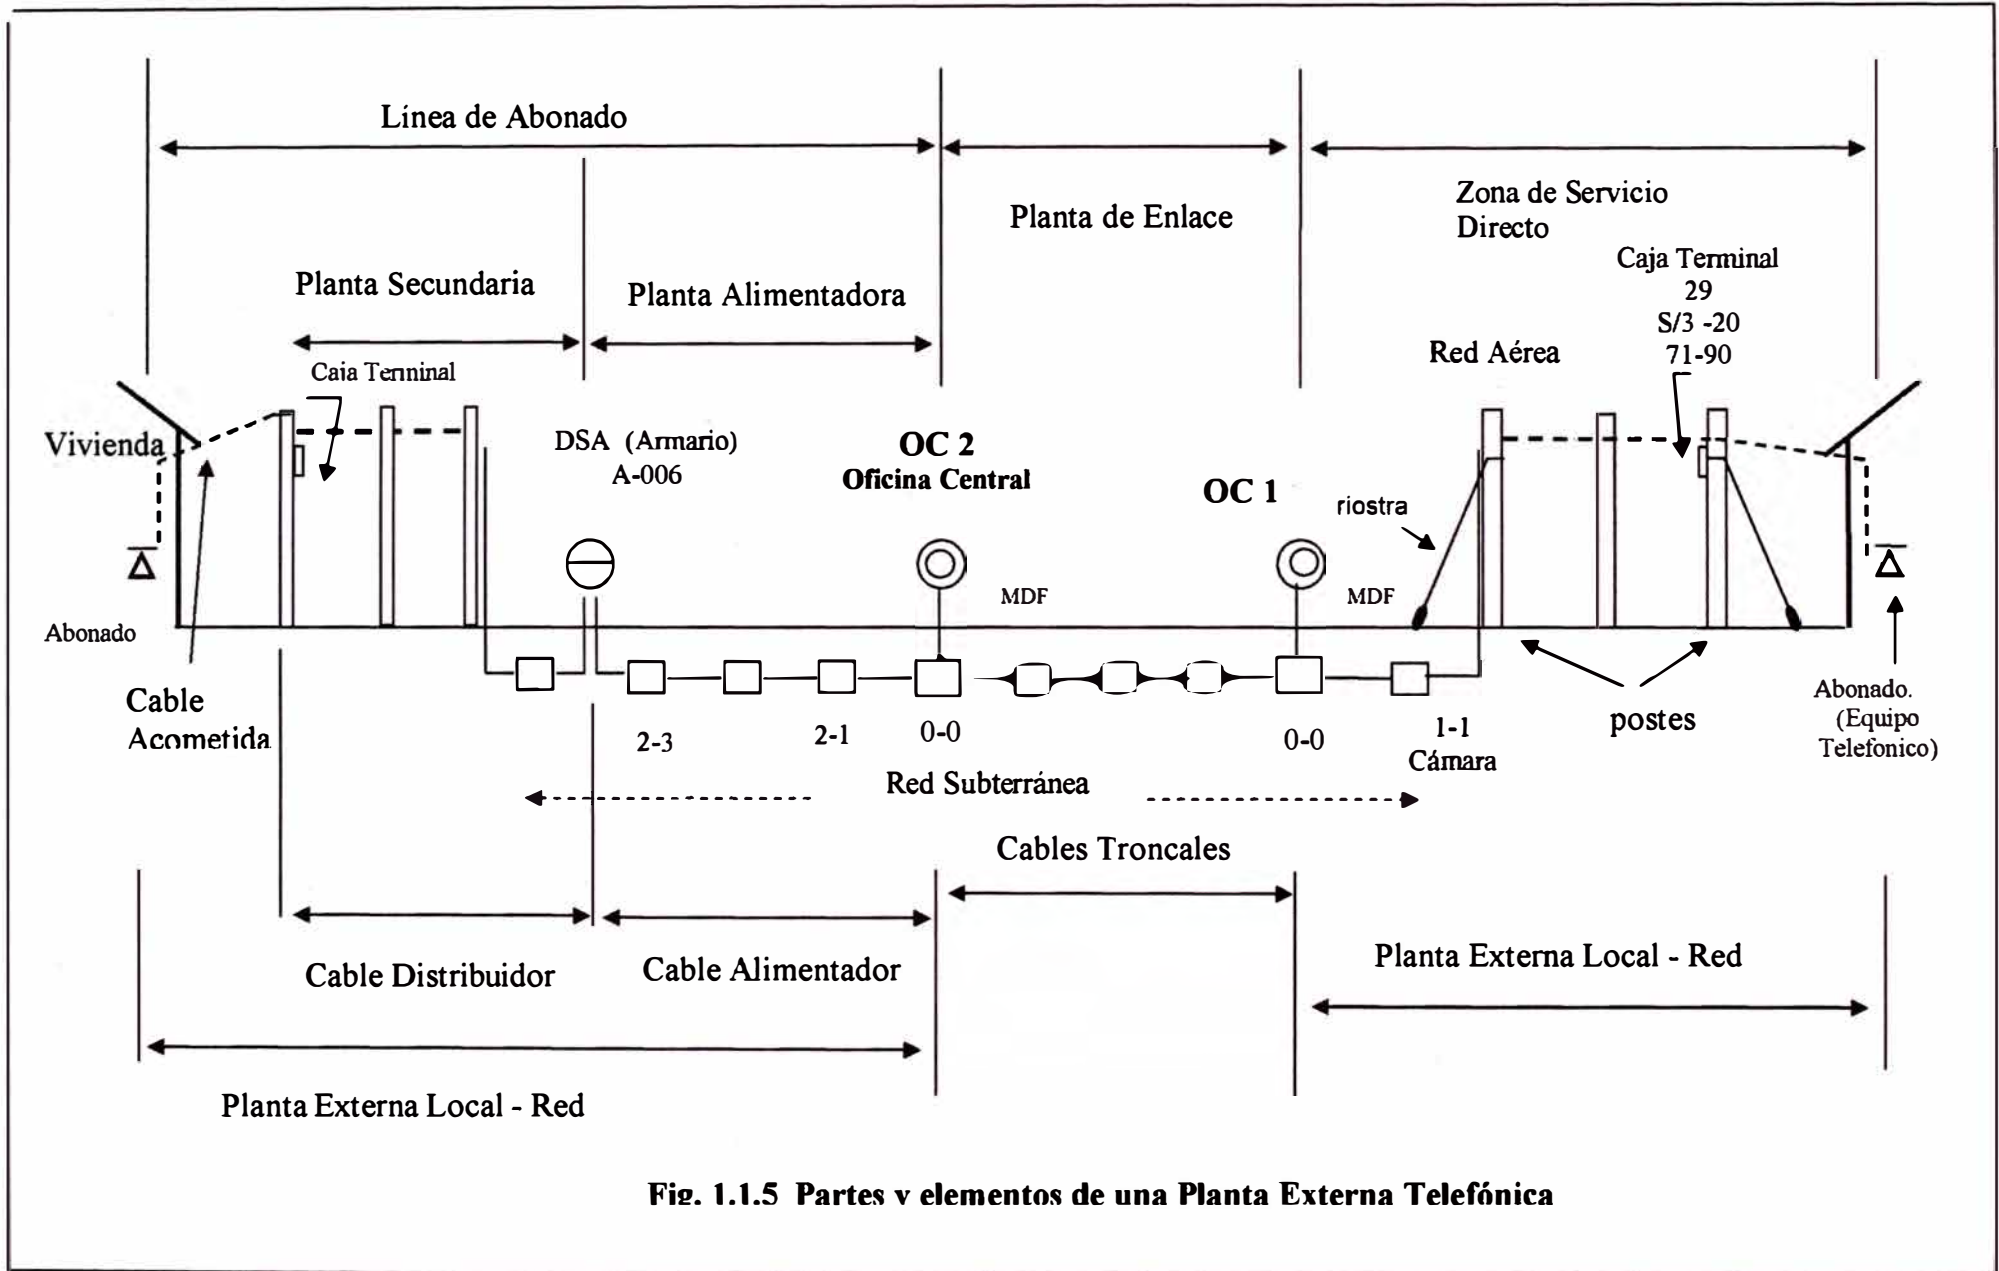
Partes v elementos de una Planta Externa Telefónica
